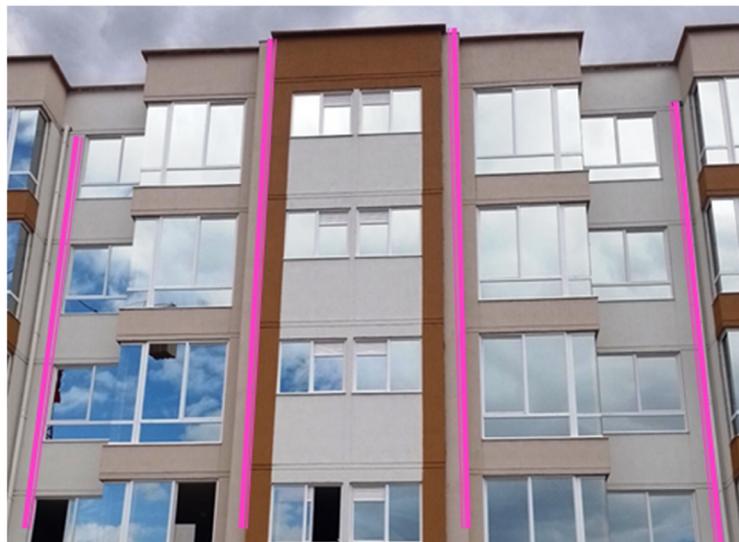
Señalización de bajantes por Torre - Fachada
